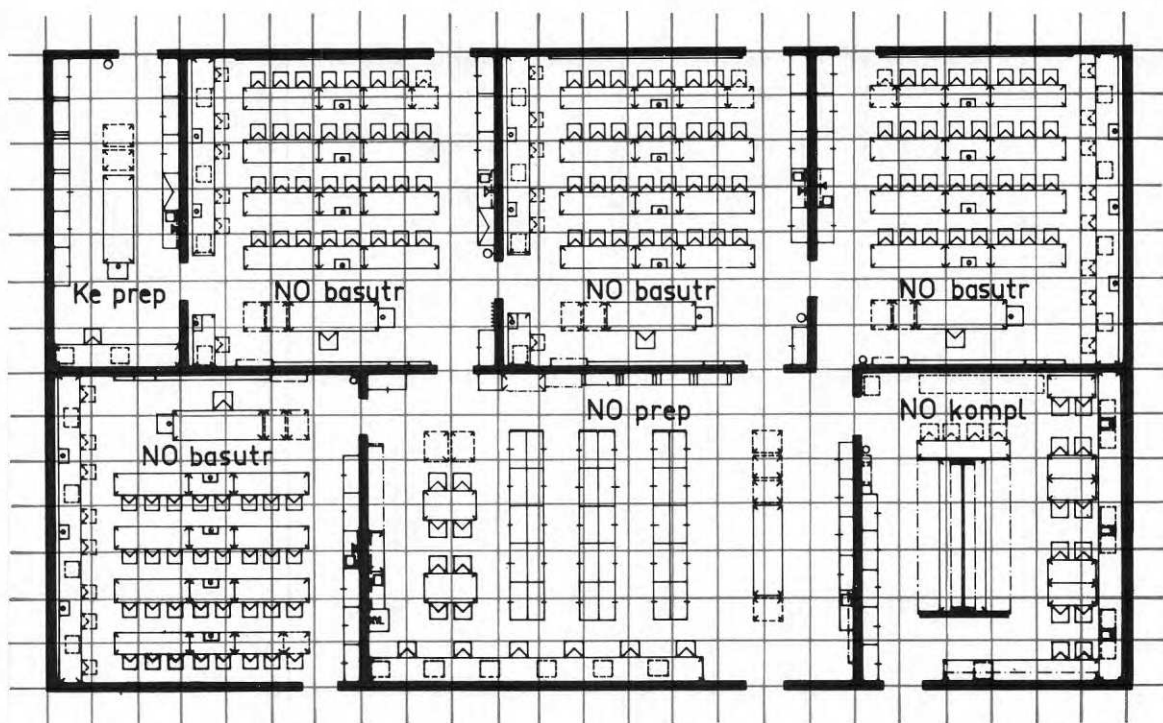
Institutioner för naturorienterande ämnen, H-stadiet, 6p.
